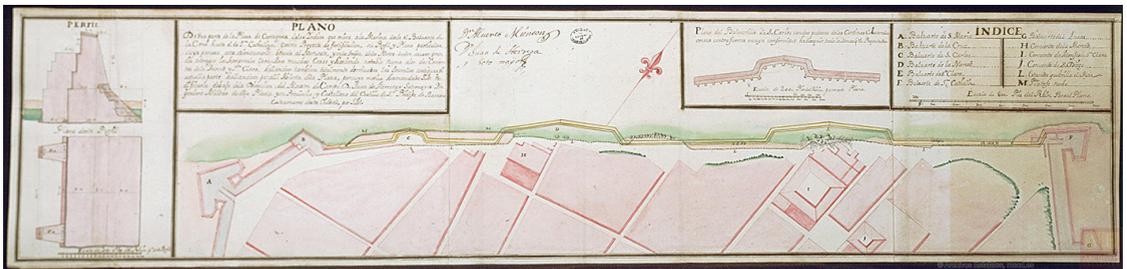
Detalle del plano que contiene una descripción del estado de la Muralla Real “una vez reparada y propuesta de escollera”, 1665
